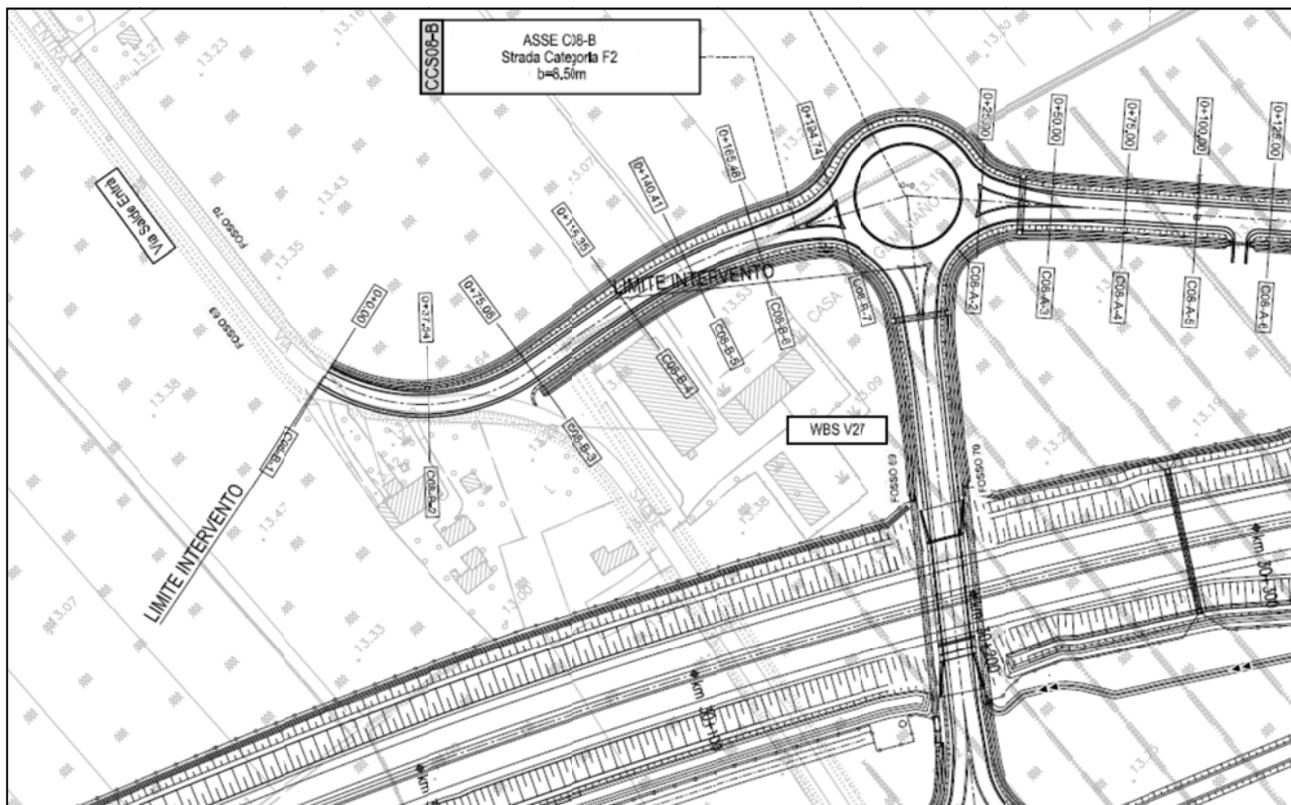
STRALCIO PLANIMETRICO TRATTO DI COLLEGAMENTO ALLA VIABILITÀ ESISTENTE
